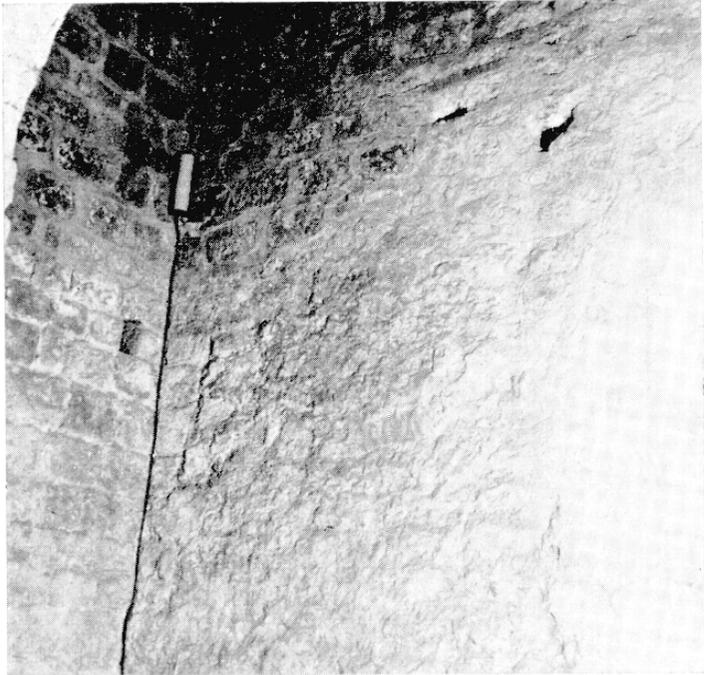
Notre-Dame sous Terre. Angle nord-ouest. Reprise de la maçonnerie du mur N. (appareil irrégulier à joints couvrant) lors de la construction du mur occidental (vers 1020).
